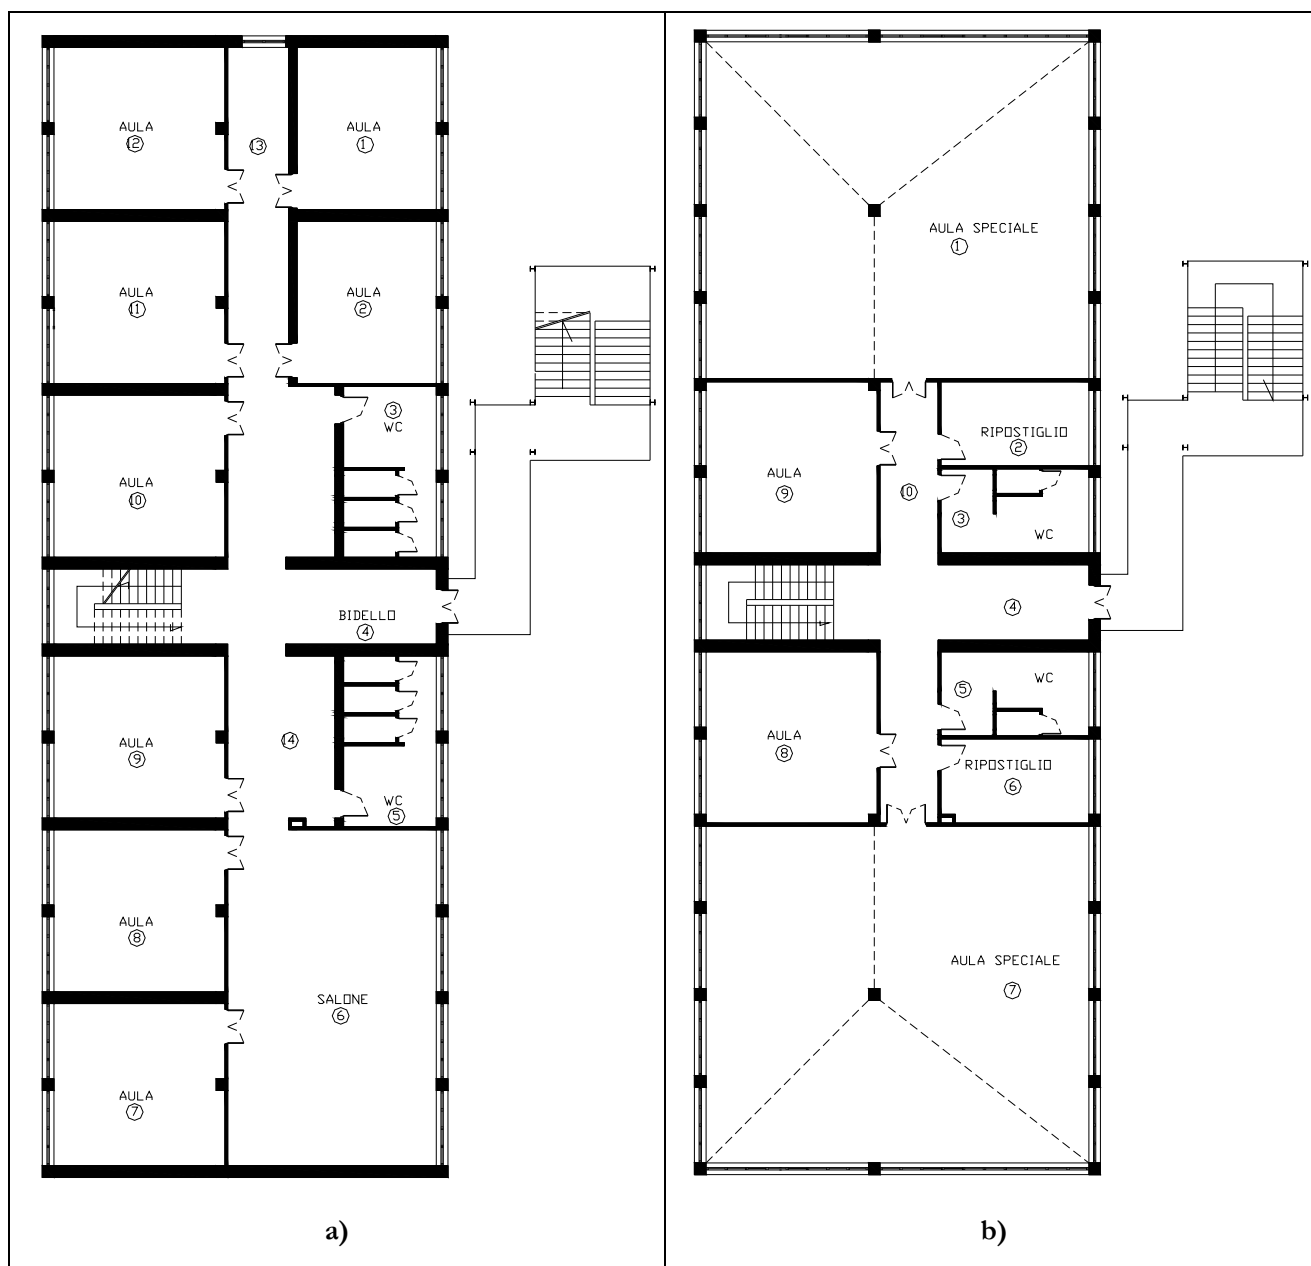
a) Pianta piano seminterrato; b) Pianta piano terra
